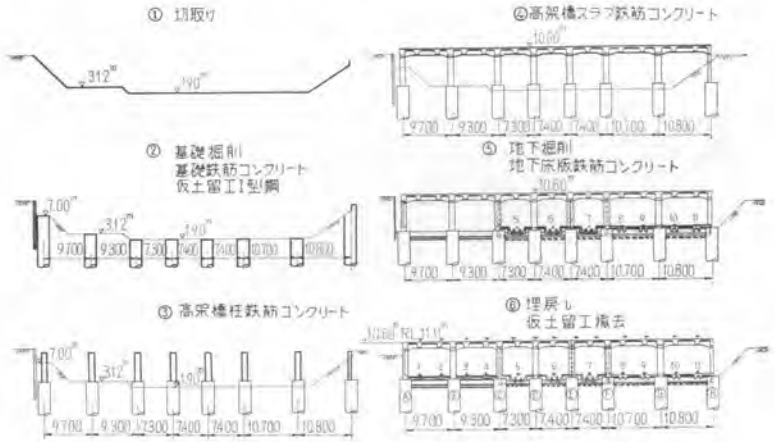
大崎電車区高架橋(鉄筋コンクリート部分)施工順序
